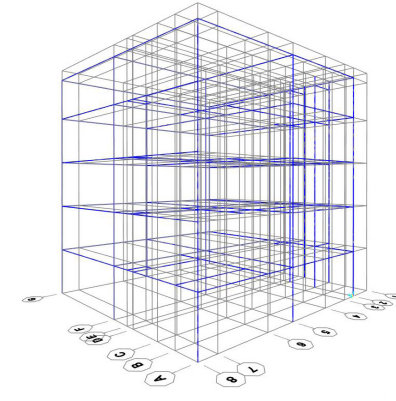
Gráfico de secciones vigas y columnas. Tipo Beam.
